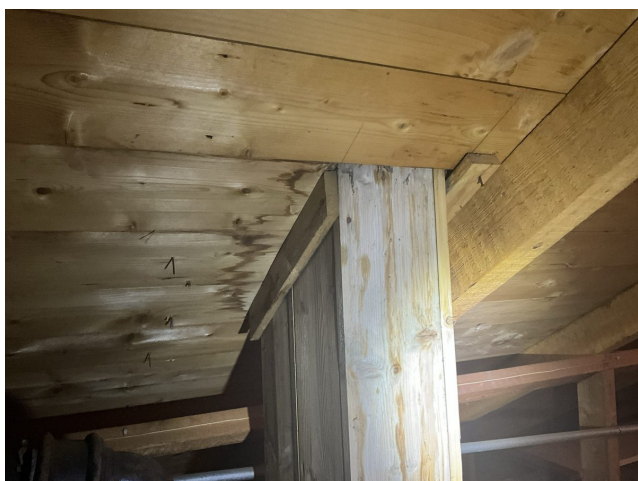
Takkonstruksjon med fuktskader på bordkledning
